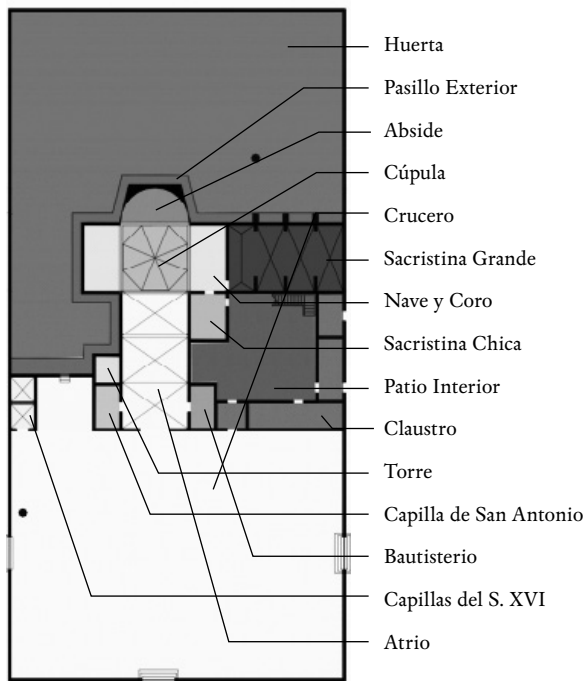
Planta del Templo de Santa María Tonantzintla antes del siglo XX. Medidas aproximadas. (Sánchez, N. 2008)
